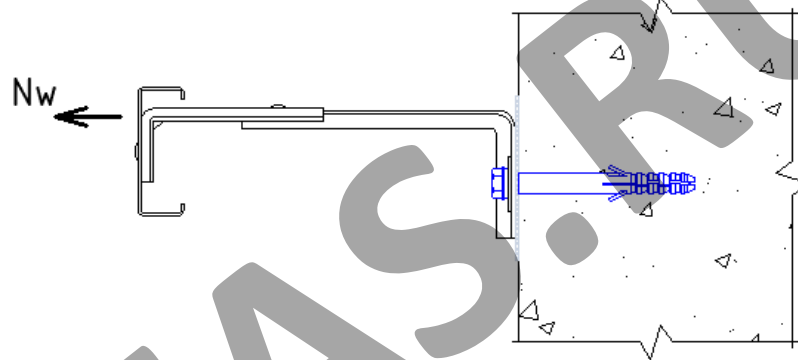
Конструктивная схема для проверки соединения направляющей с кронштейном
